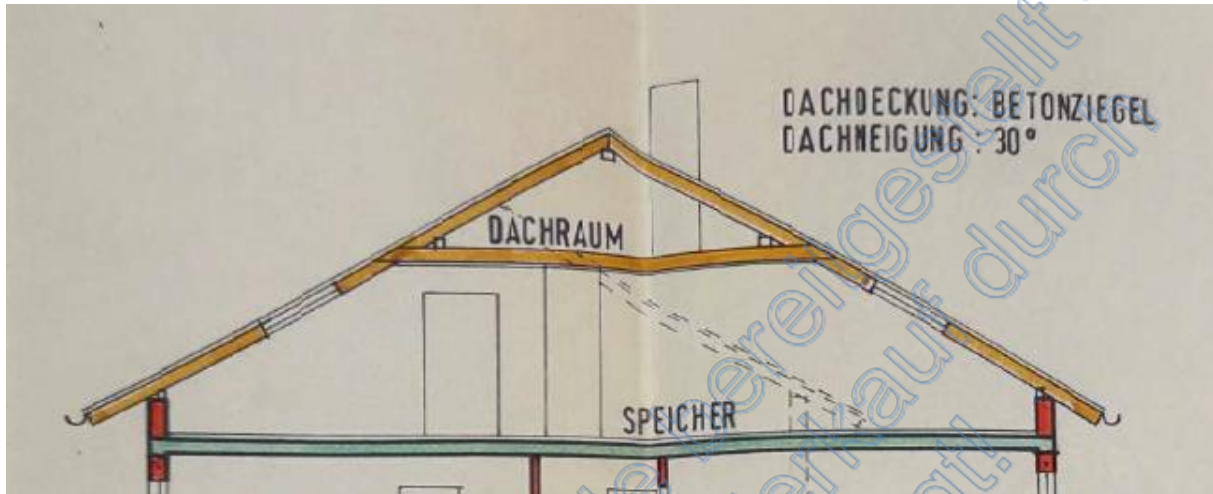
Ausschnitt aus Querschnittsplan des Dachstuhls
